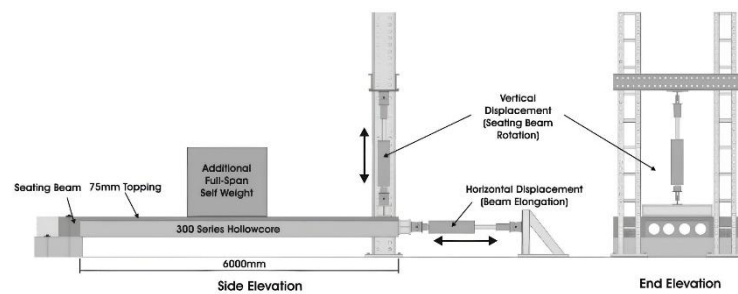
Exemplo de instalação para um ensaio, no âmbito do ReCast Floors, em sub-montagem de uma laje alveolar [26]
